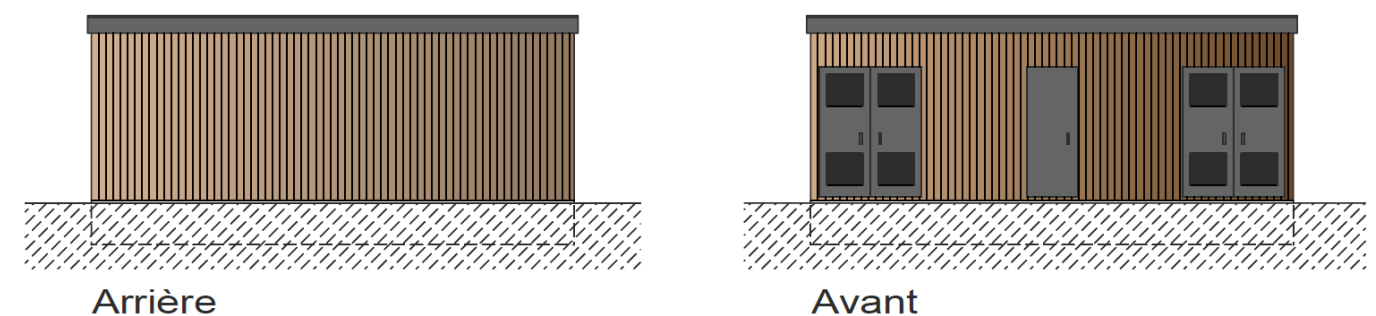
Vues des façades du poste de livraison prévu sur site
